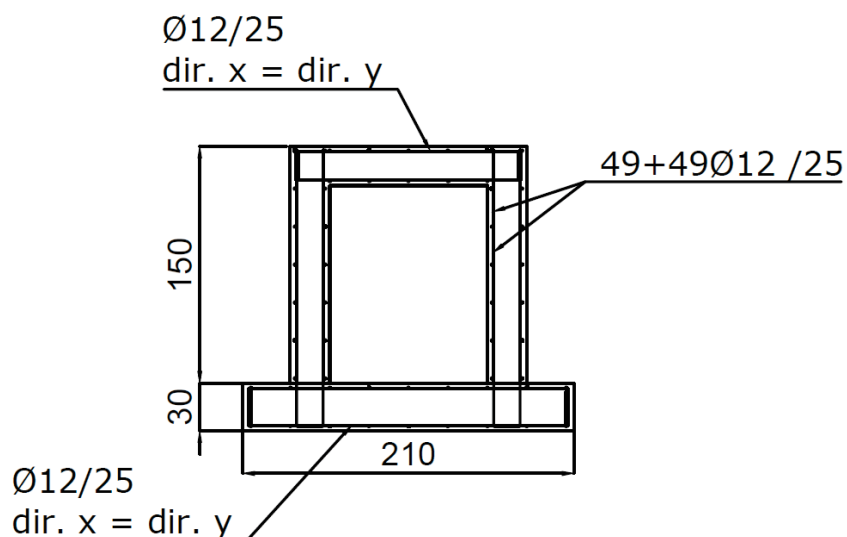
Sezione trasversale dell'opera di attraversamento dell'impluvio
